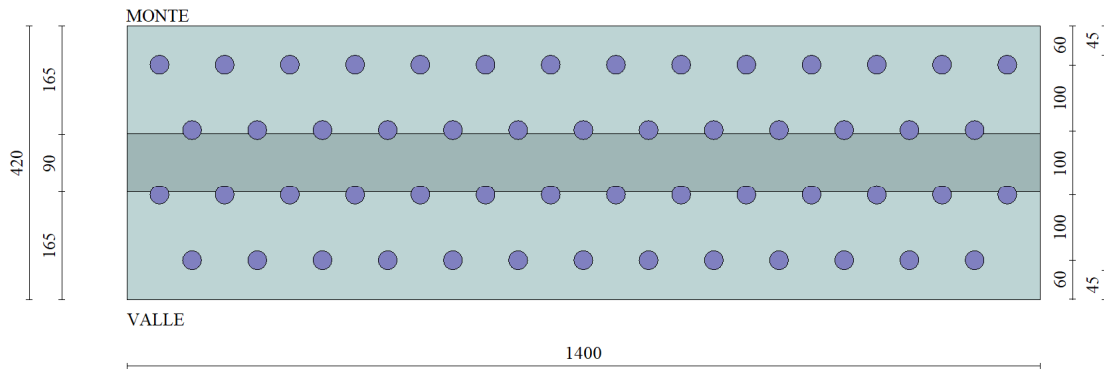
Muro Tipo D: disposizione dei micropali di fondazione.
